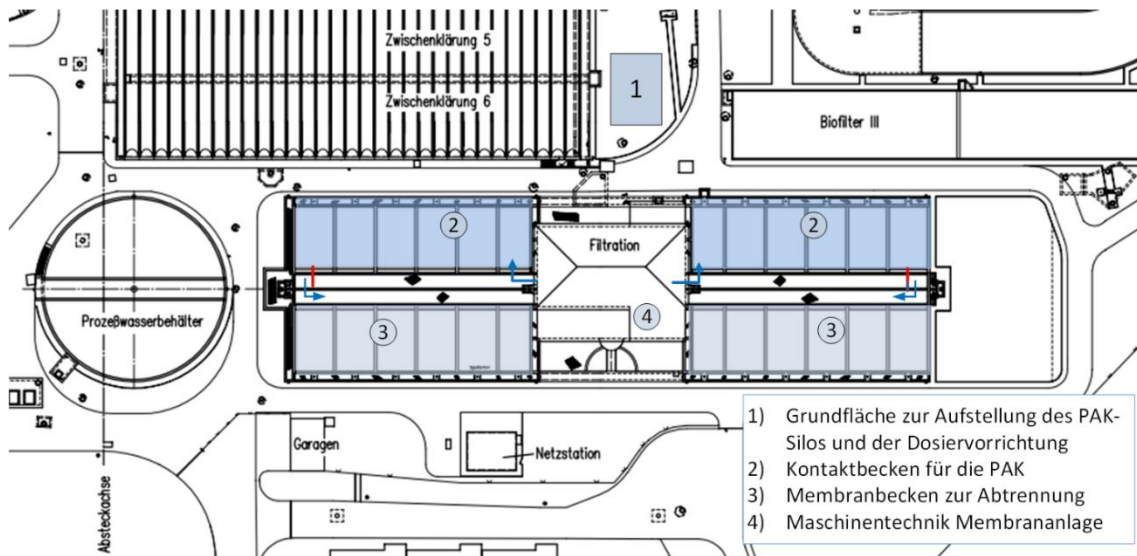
Lageplan der Variante 4 auf dem Klärwerk Krefeld
